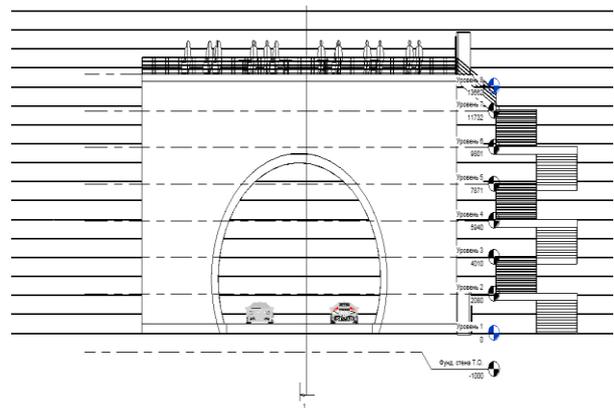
Архитектурно-планировочное решение (фасад - южный)
